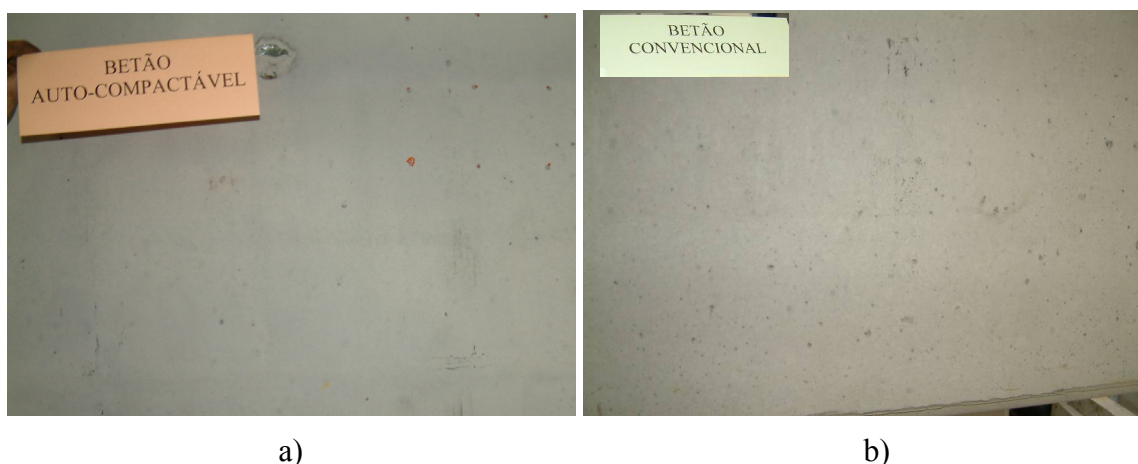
Aspecto da superfície lateral interna: a) box-culvert betonada com BAC; b) box-culvert betonada com BC
